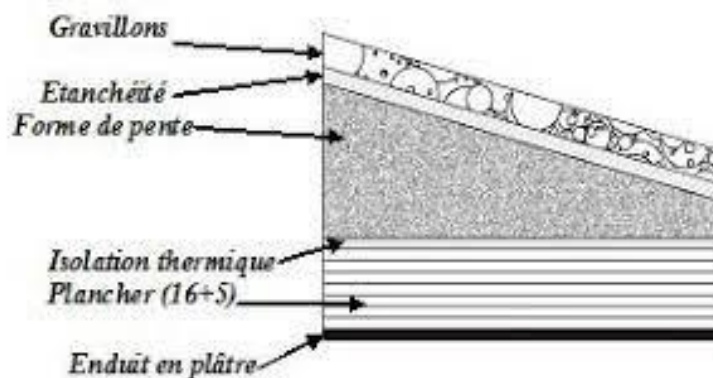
Coupe verticale du plancher terrasse (inaccessible)
